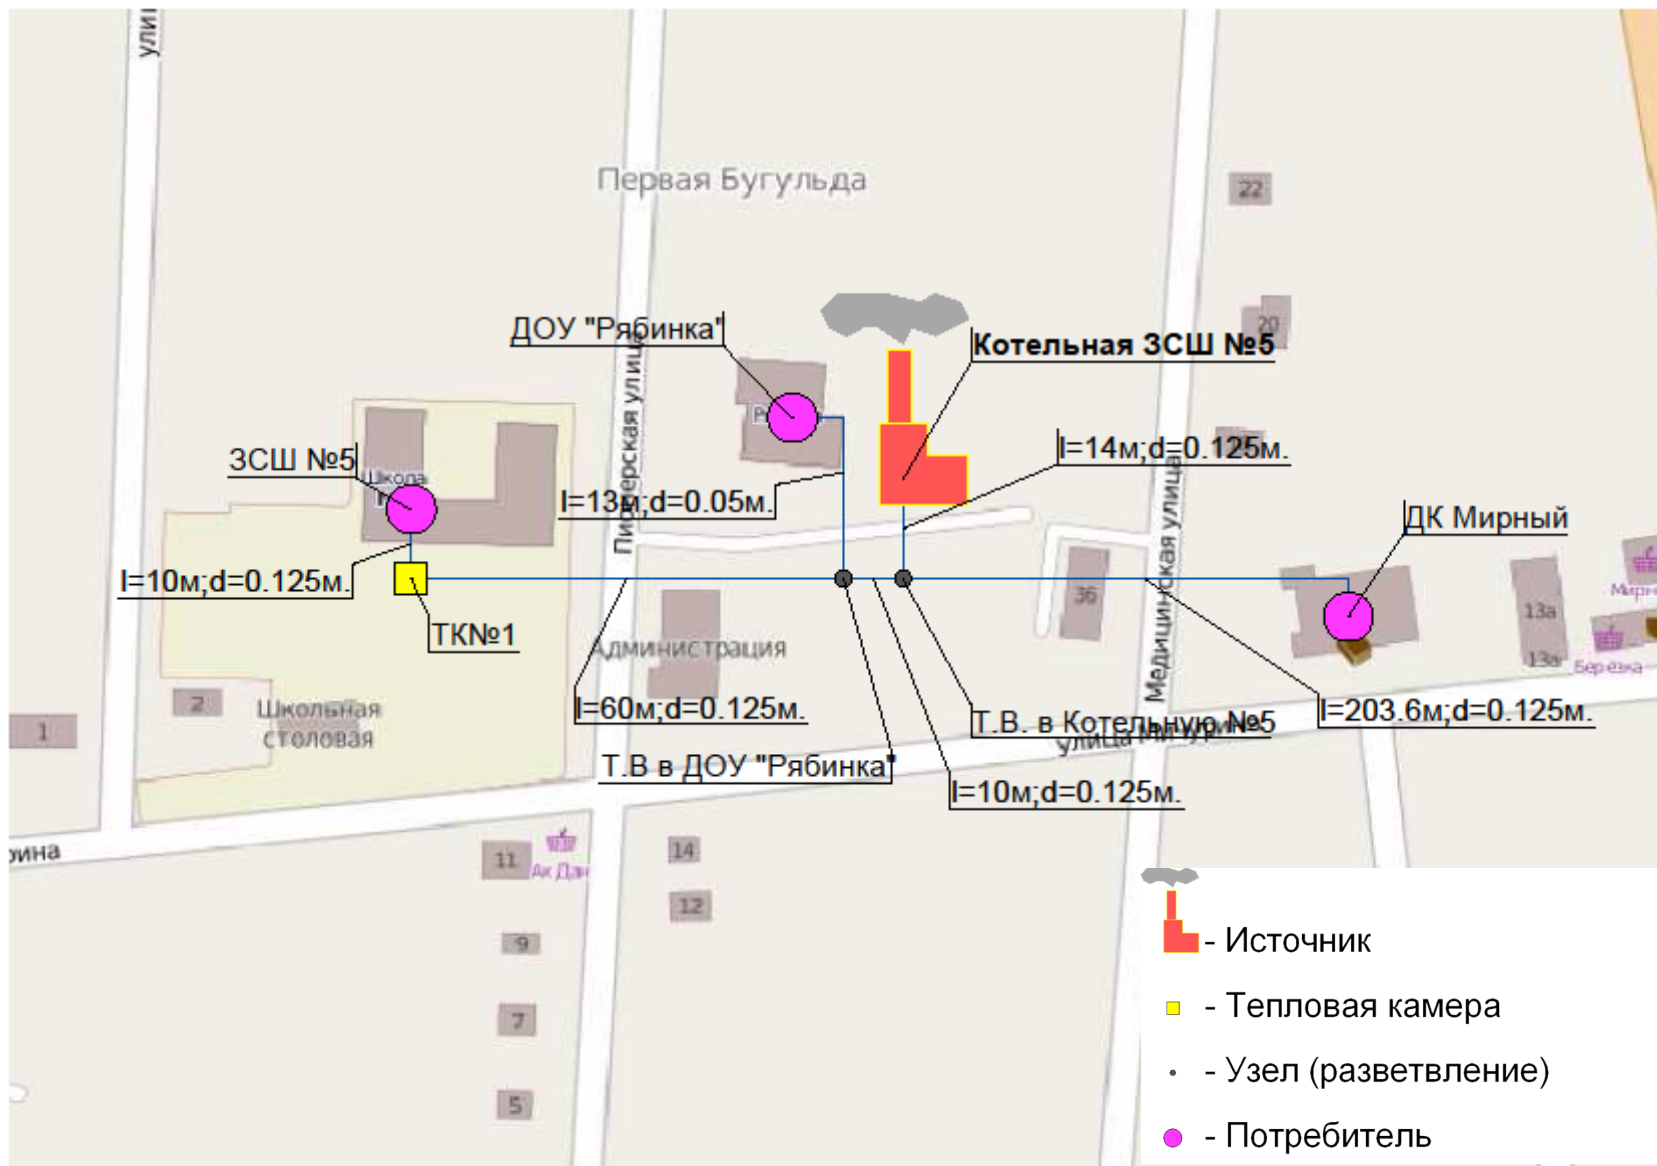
Схема тепловых сетей котельной ЗСШ №5 п.Мирный
